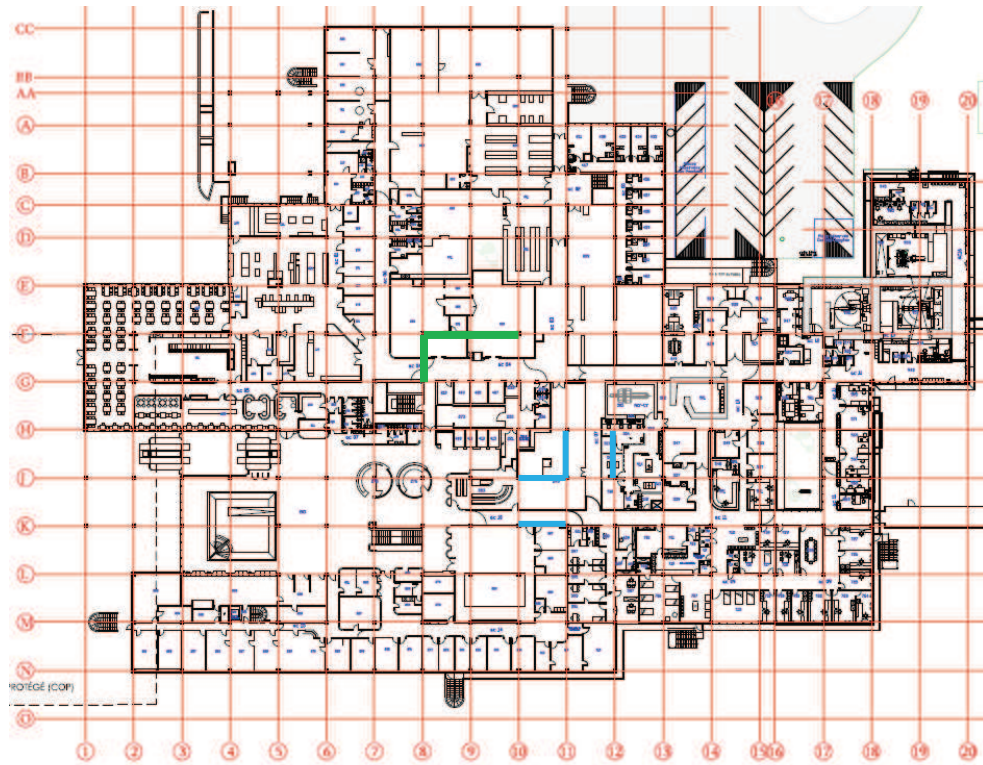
Plan du rez-de-chaussée, niveau A. Nouveaux murs en béton armé.
